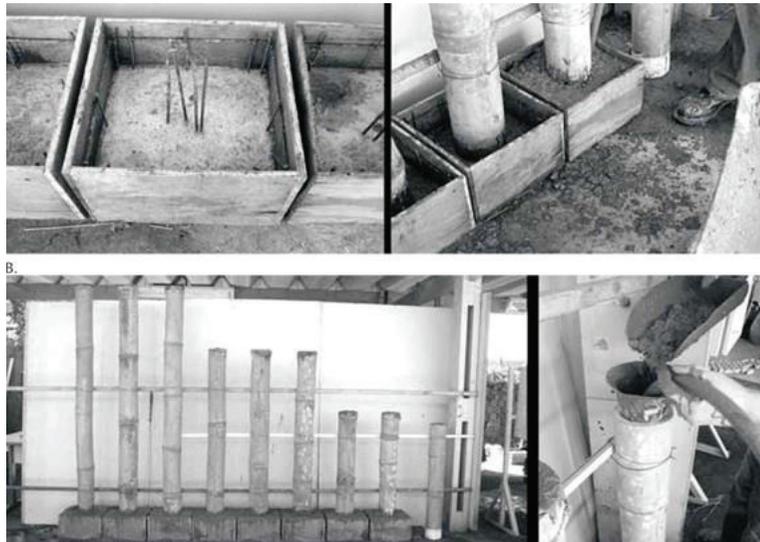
Fundação em Betão Armado e Pilares de Bambú (DOS SANTOS,
